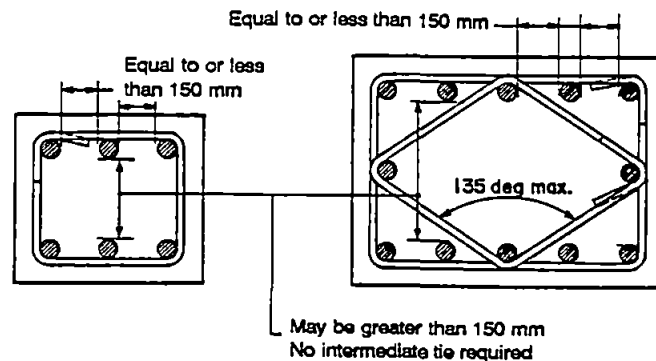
Croquis para aclarar las medidas entre barras de columna apoyadas lateralmente.
